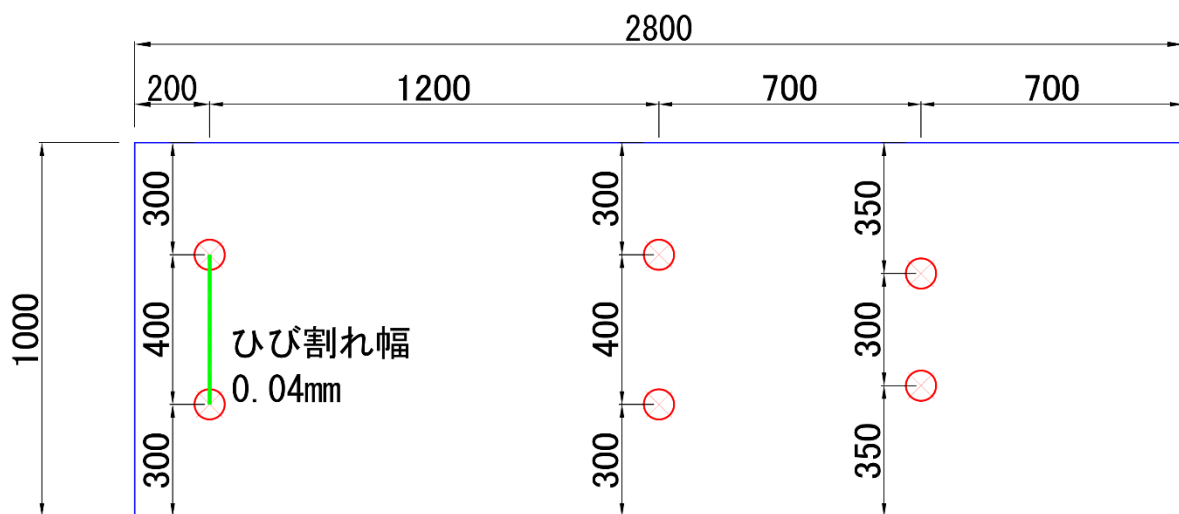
ひび割れの発生状況（静的破砕剤充填 24 時間後）
